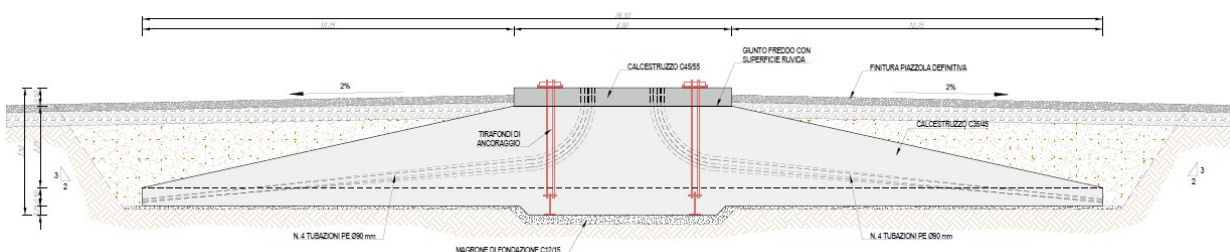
Schema tipo della fondazione dell'aerogeneratore, con plinto a tronco di cono
